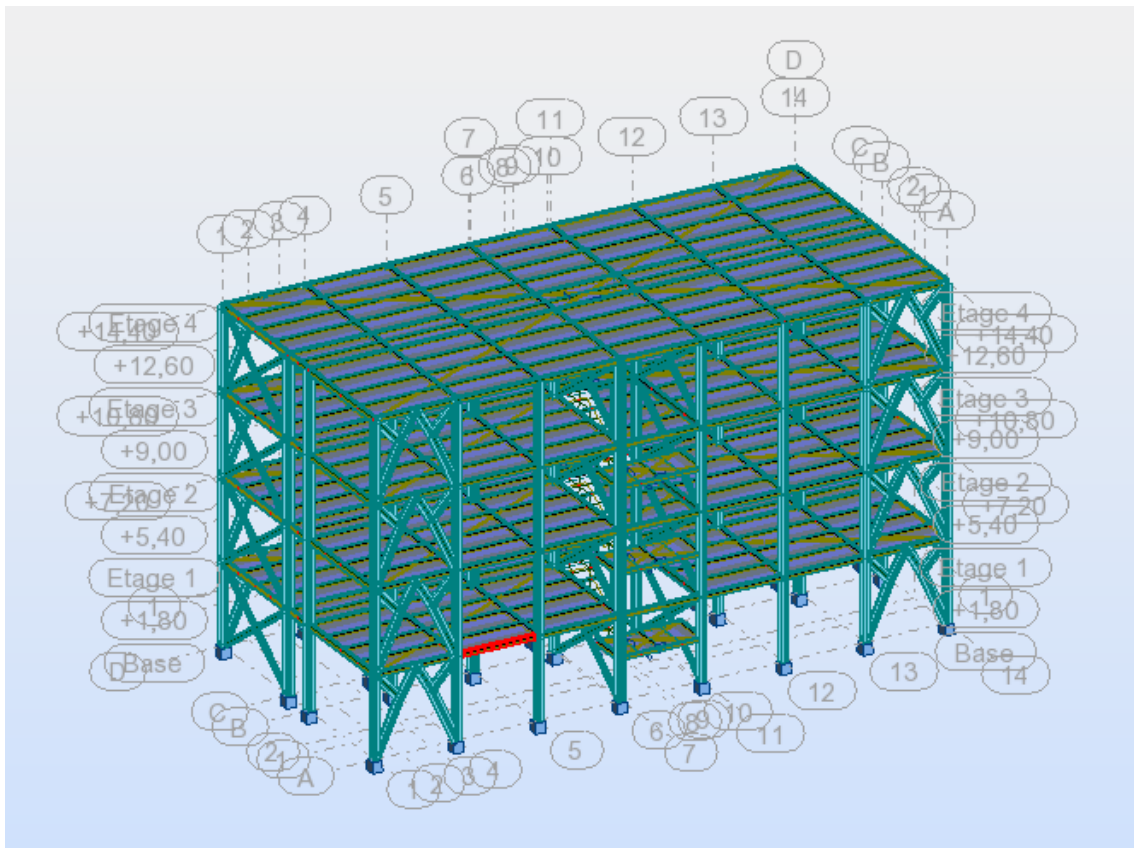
la poutre secondaire la plus sollicitée.
